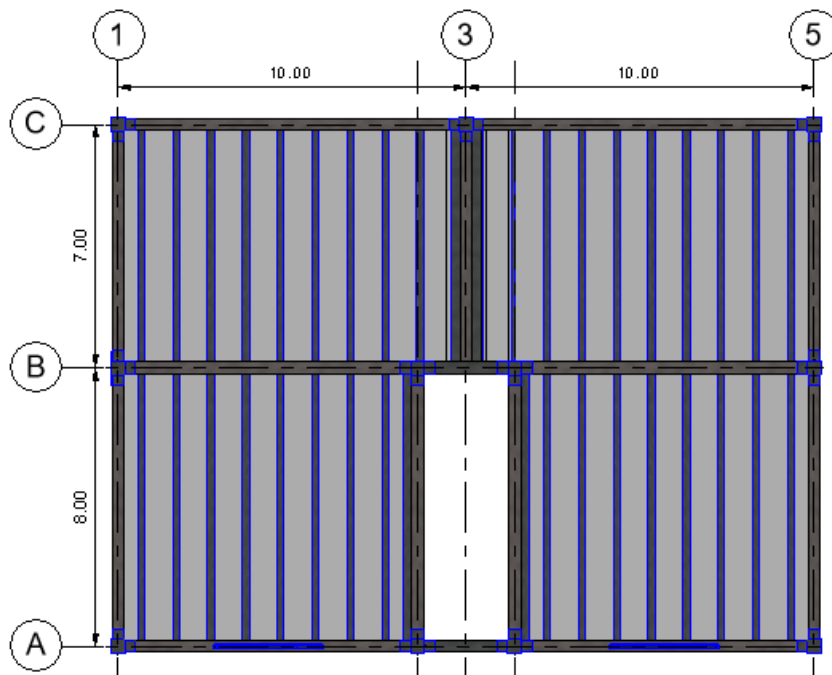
Disposición de prelosa en planta típica de edificio prefabricado
